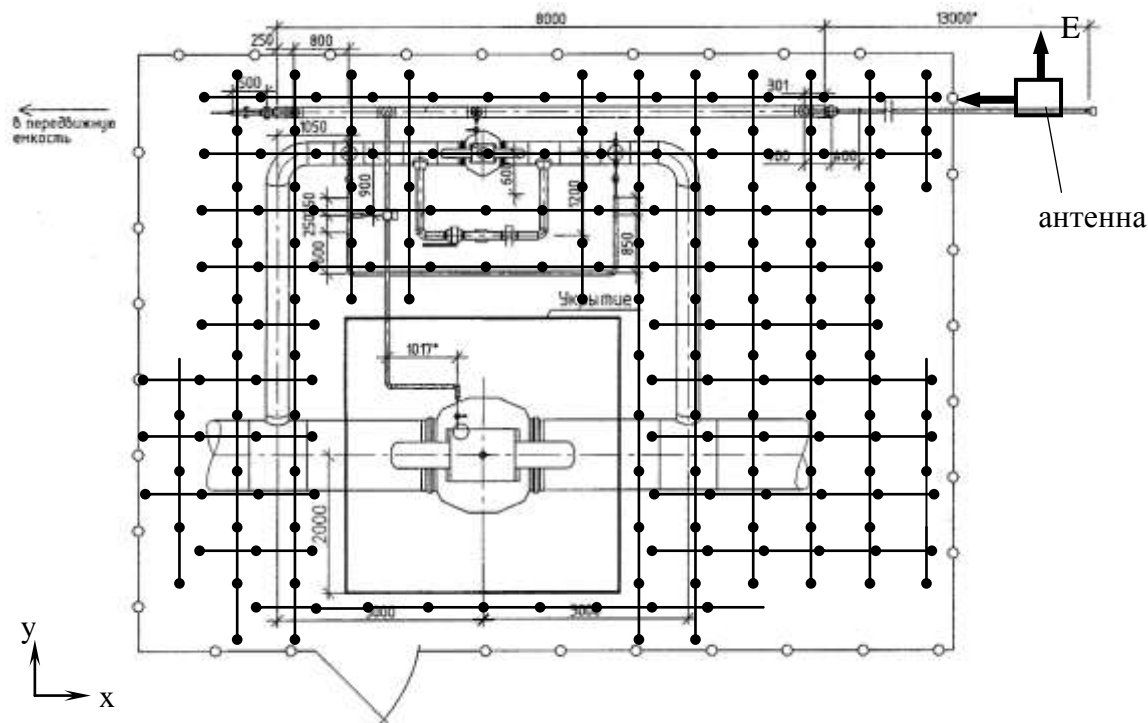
Схема сканирования грунта площадки кранового узла
